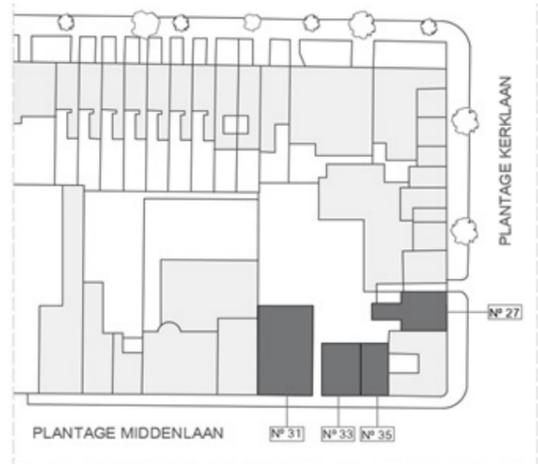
Plano de situación antes de la construcción de la Hubertus House. Elaboración propia.
